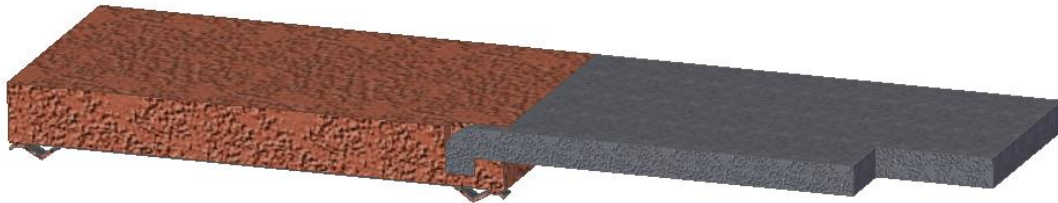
Corte del detalle de enganche entre placas
